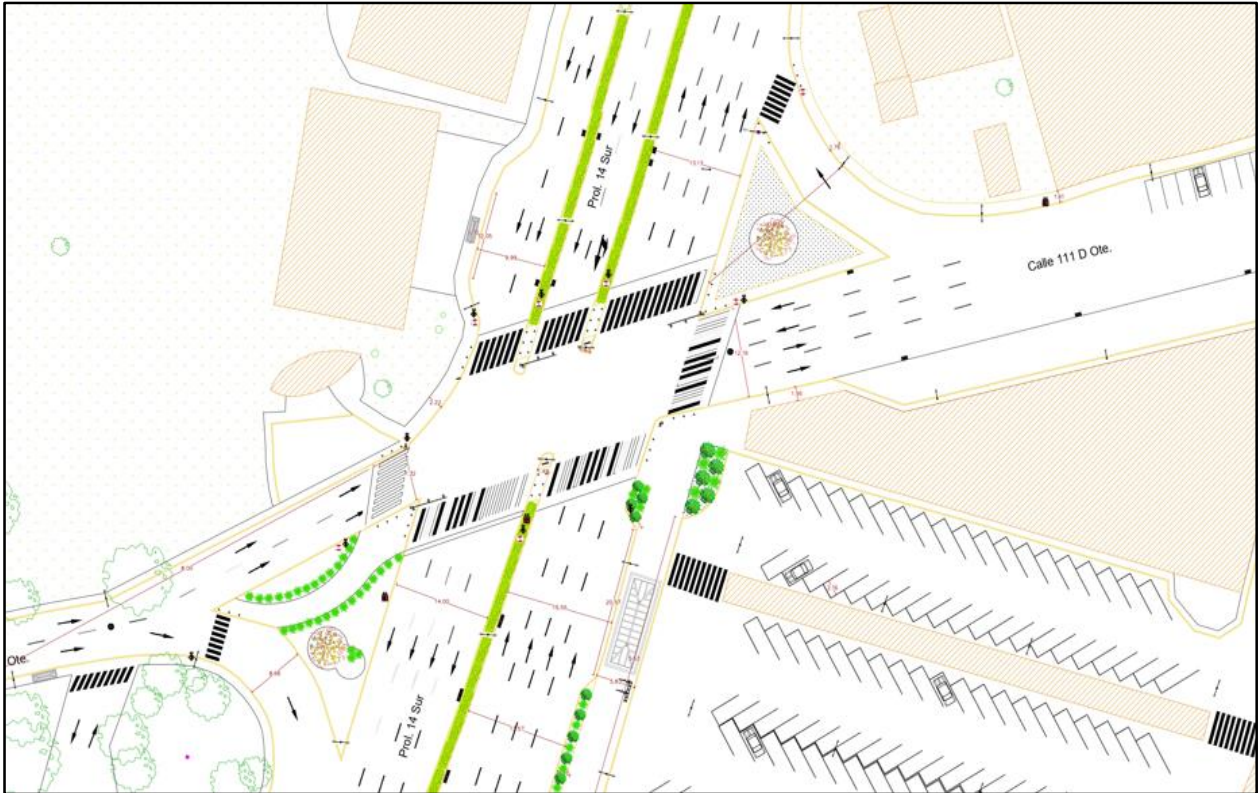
Plano de conjunto de propuesta de infraestructura peatonal y renders
